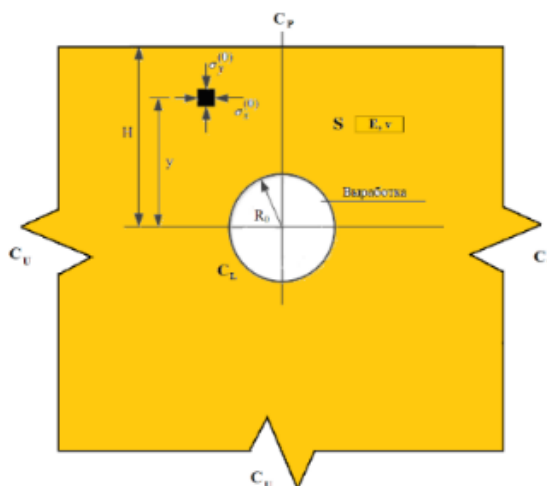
Схема к определению НДС вокруг тоннельной выработки
